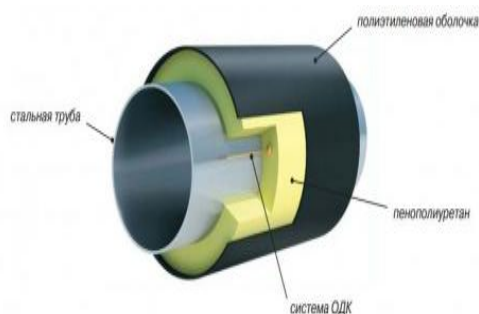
Антикоррозийное покрытие пенополиуретановой (ППУ) гидроизоляцией
